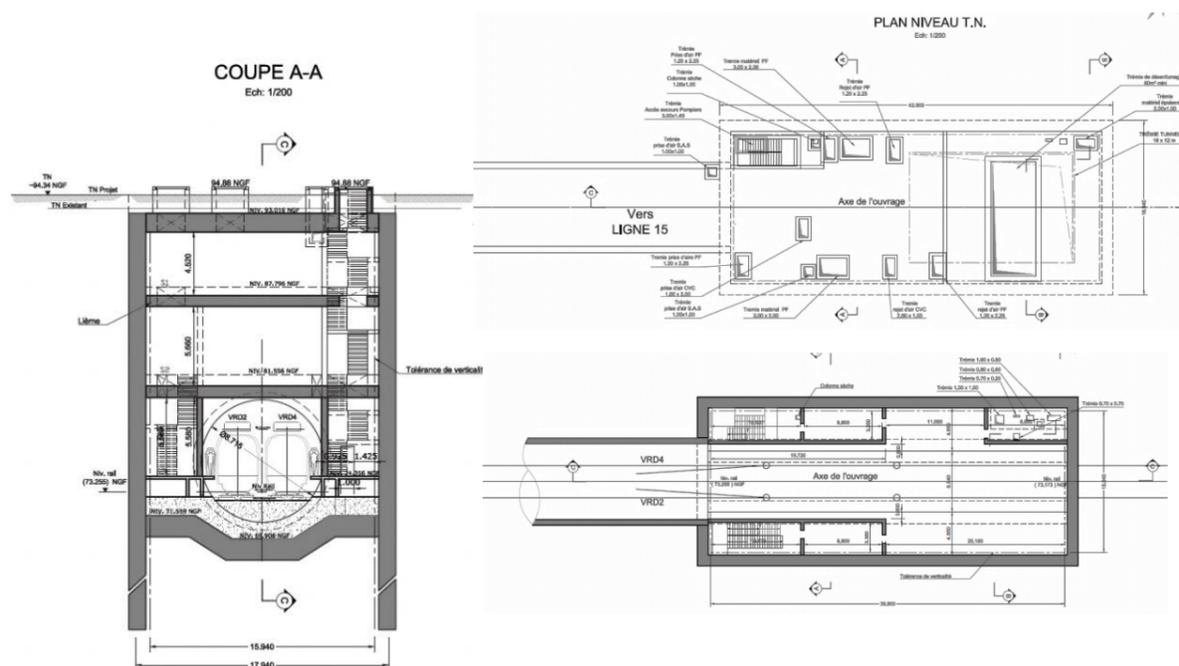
Coupe / Vues en plan niveau Tunnel - Vue en plan Niveau TN OS 0807P
